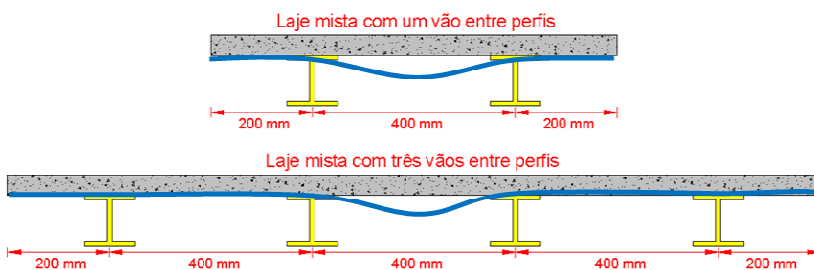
Sistema de laje Mista com um e três vãos entre perfis.
